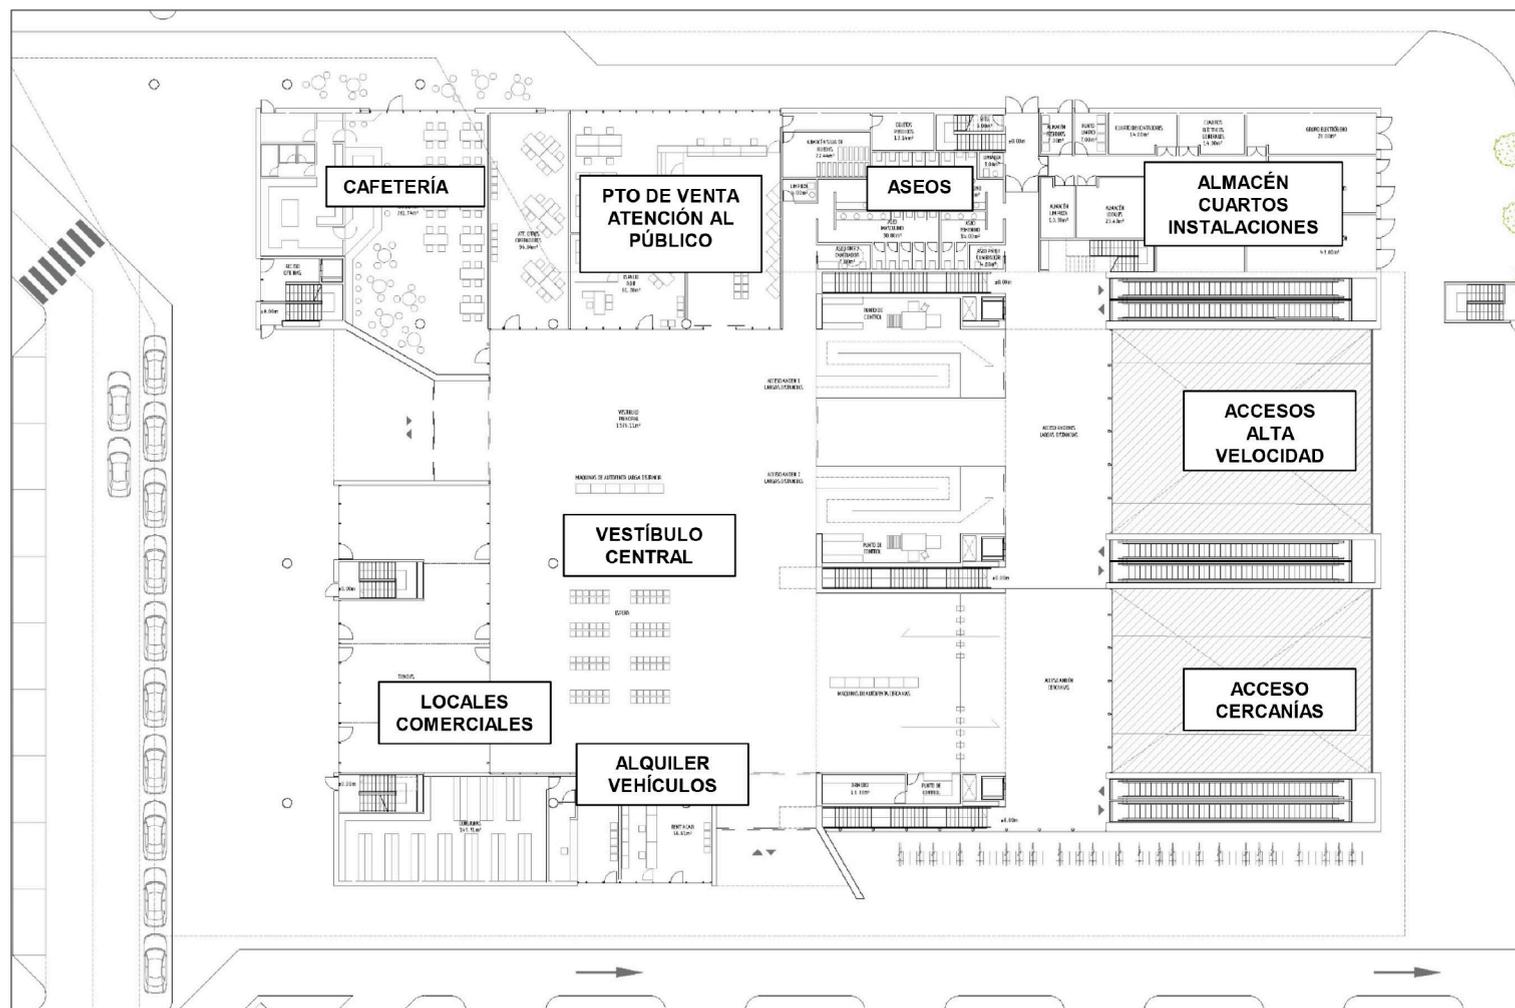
Distribución interior de la estación. Planta baja.(Fuente: Proyectos de construcción RAF Murcia. Soterramiento de Estación y Barriomar y Nonduermas”, noviembre 2018, ADIF)
